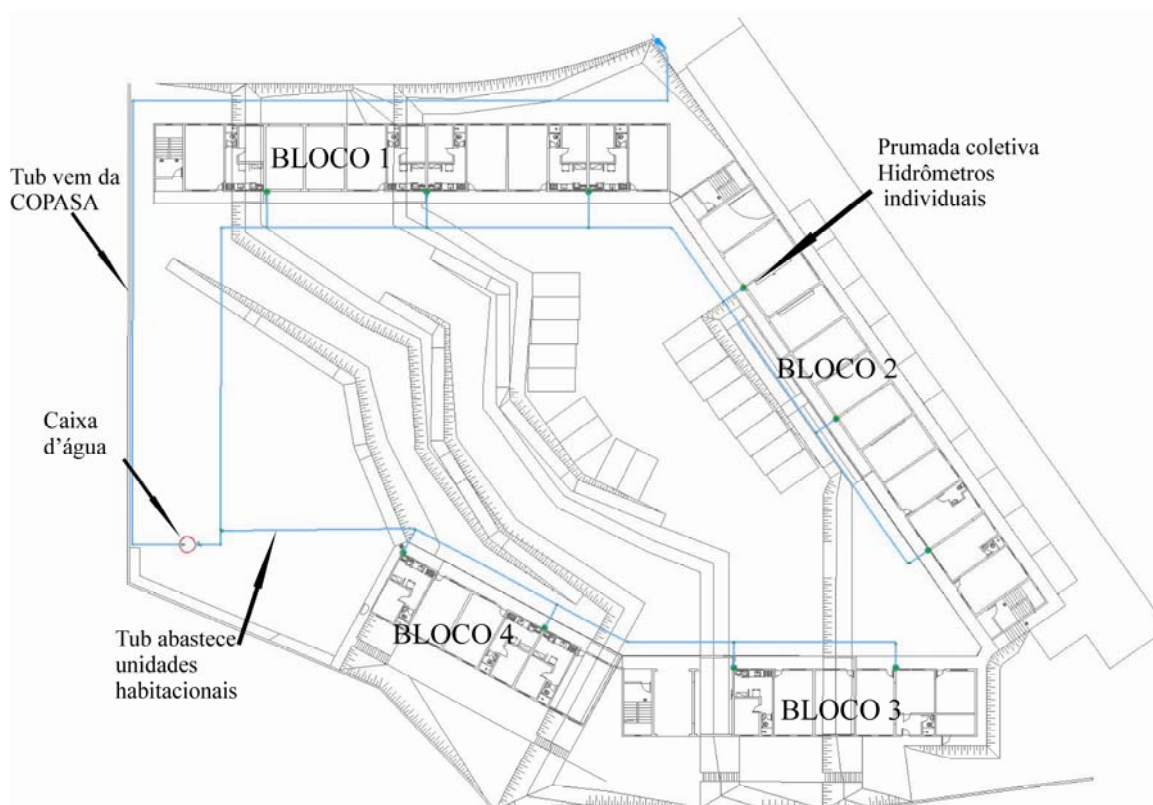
Tipologia fita – Esquema de distribuição das instalações hidráulicas - Implantação
